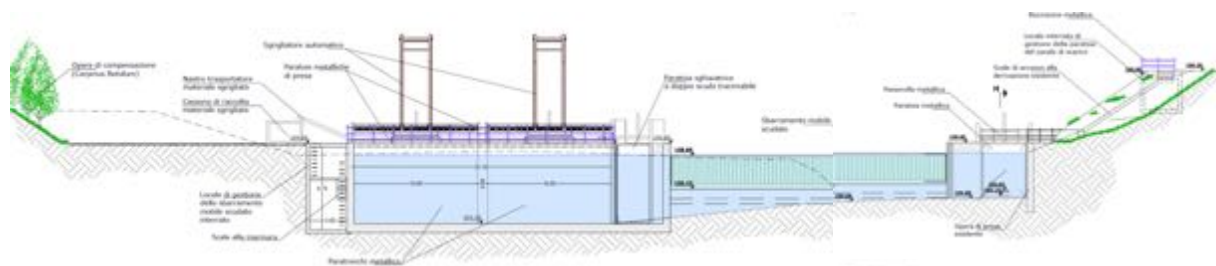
Sezione longitudinale turbina Kaplan "PIT"
